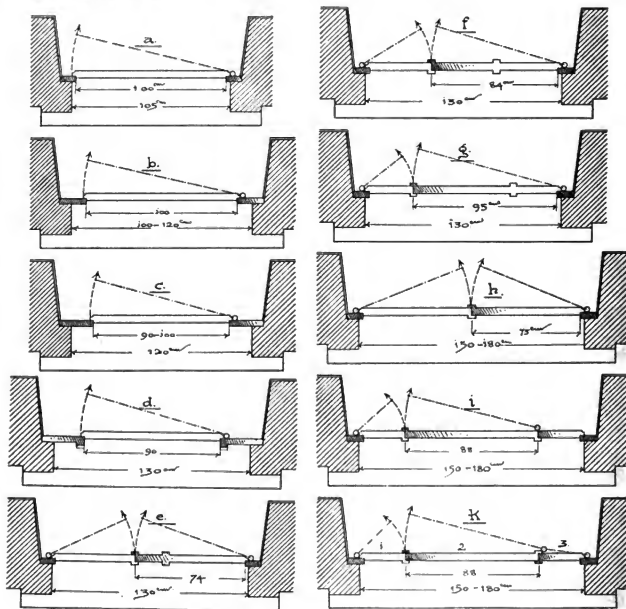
Grundriß-Anlagen von Hauseingangsthüren.
